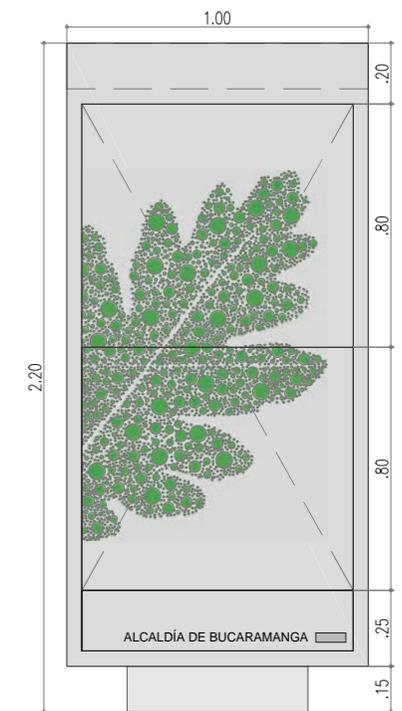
Fachada puesto de venta estacionario tipo 1. Esc 1:25
